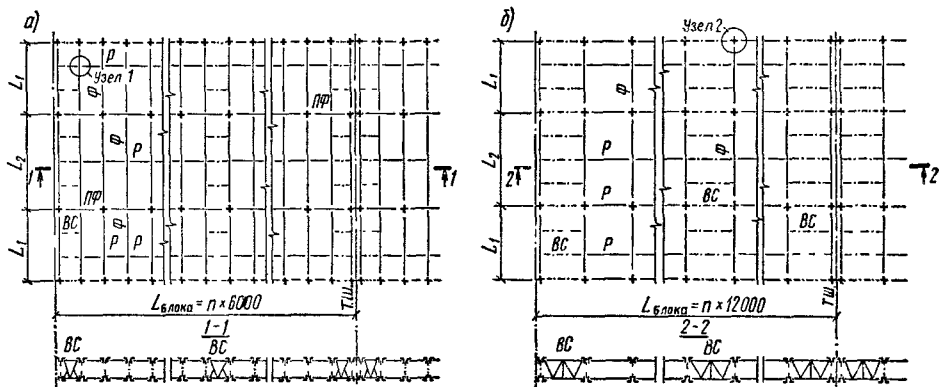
Схемы расположения элементов конструкций покрытия в уровне верхних поясов ферм при применении железобетонных плит
